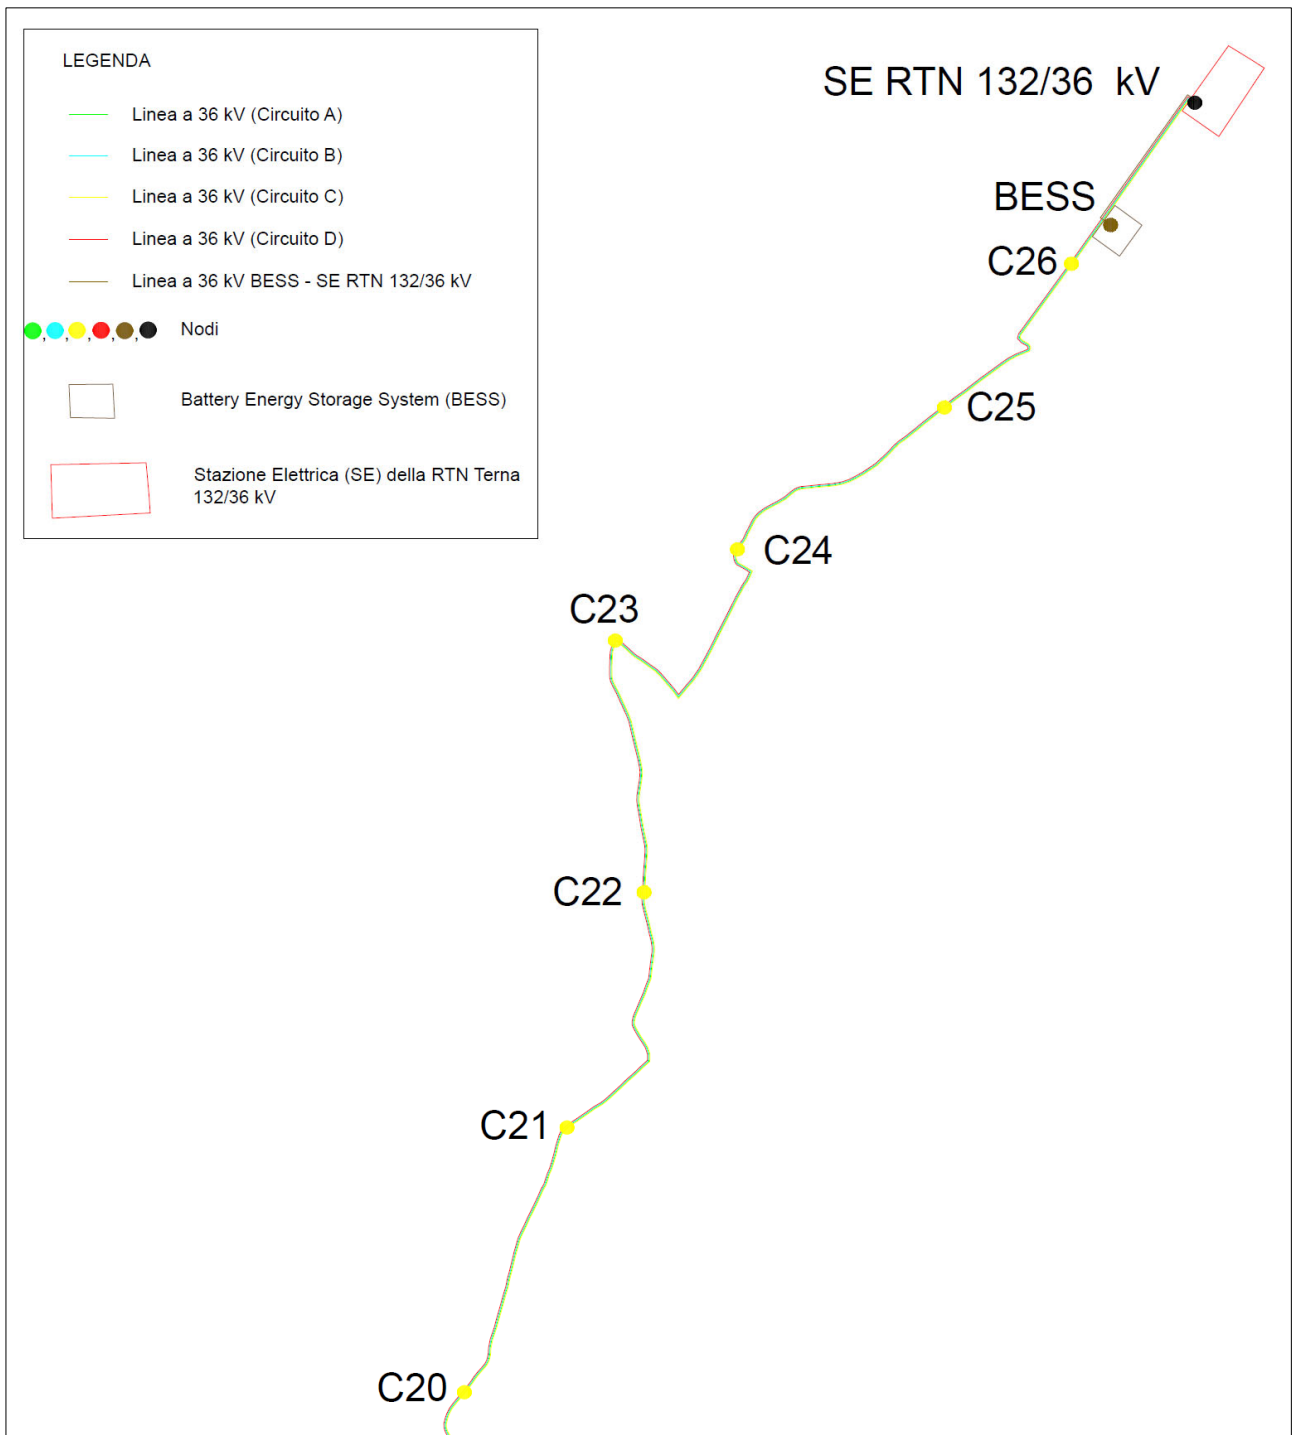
Dettaglio 3 della planimetria di distribuzione linee a 36 kV
